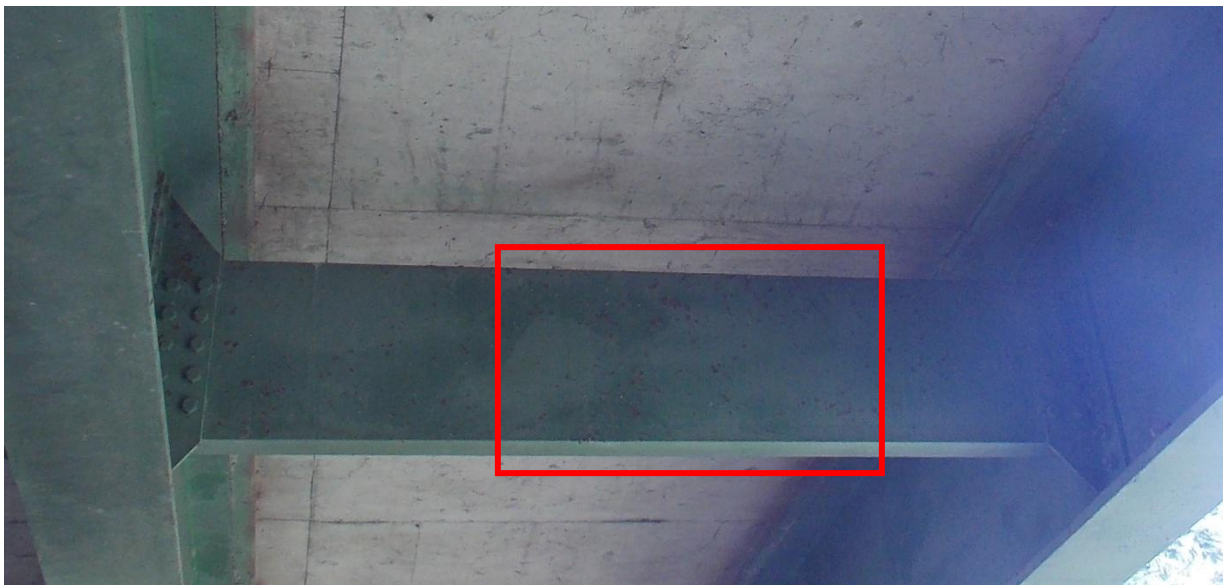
Piquetes de corrosión y desprendimiento de pintura típico en las vigas diafragma de acero.
